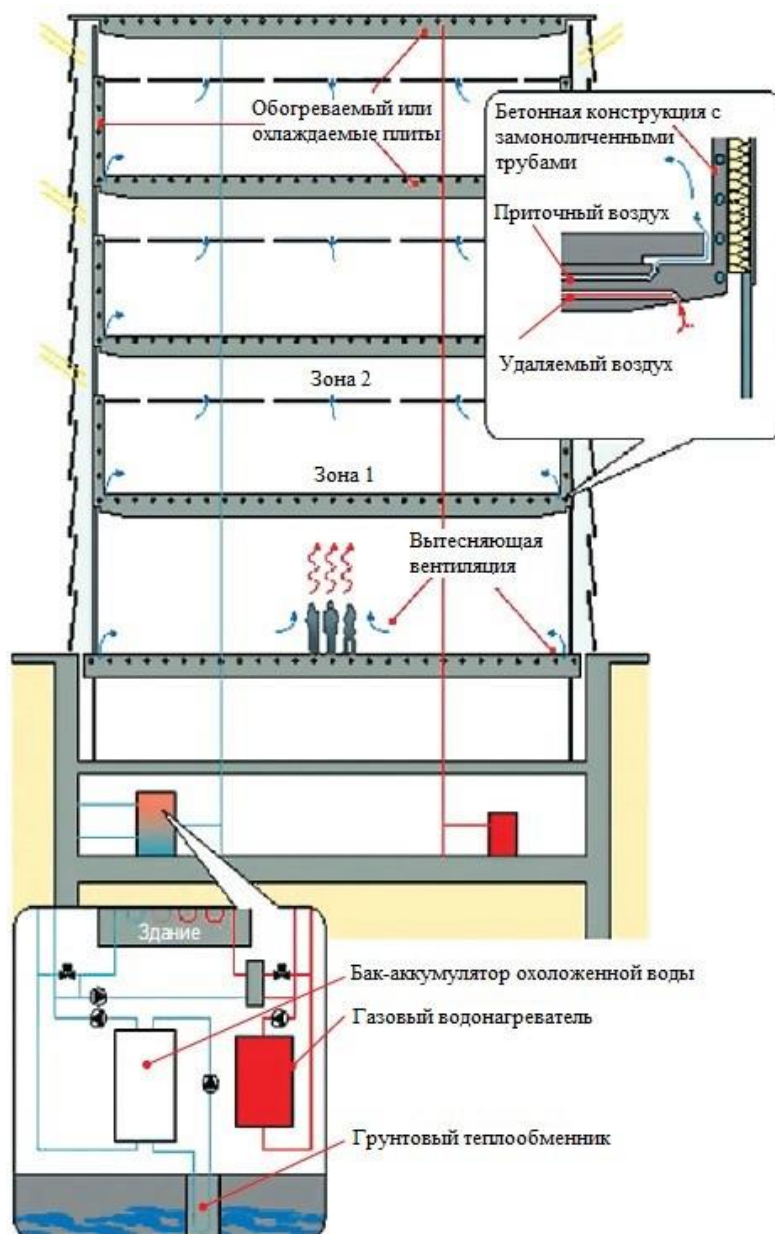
Схема кондиционирования офисного здания с помощью охлаждаемых строительных конструкций
